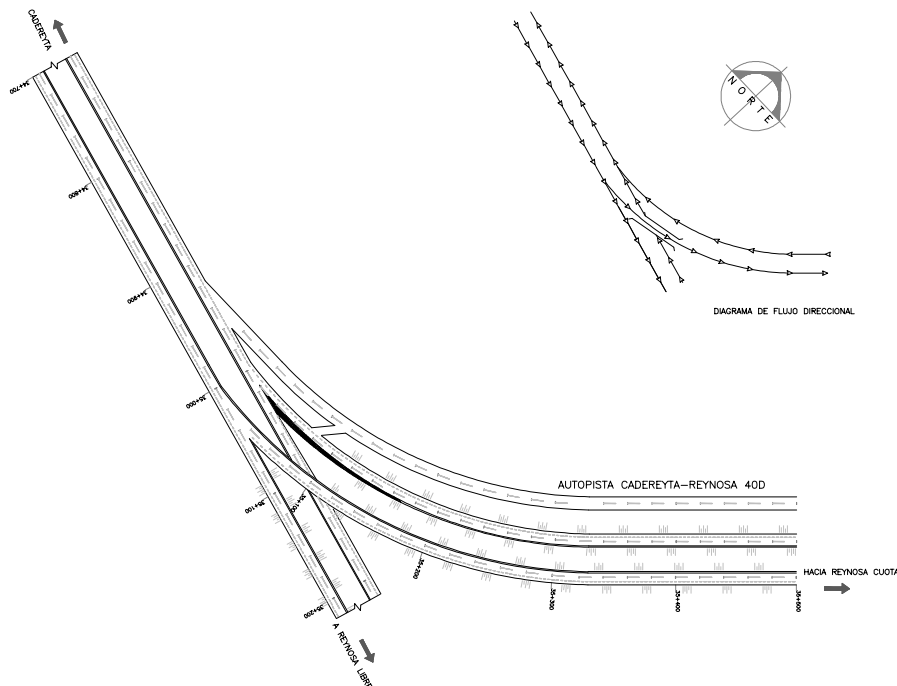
Planta del Entronque “Cadereyta”
